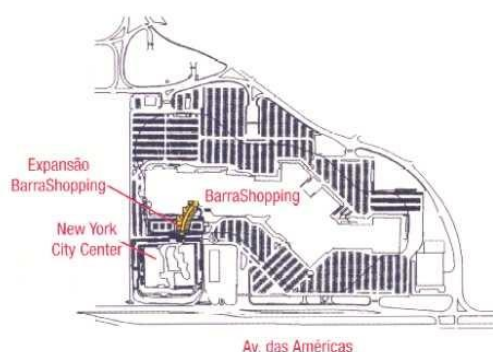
Planta expansão/união BarraShopping/New York City Center.
